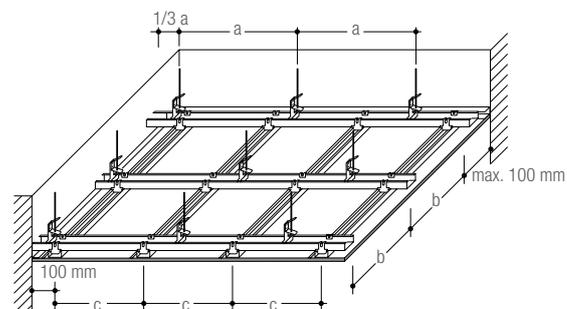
Abgehängte Metallunterkonstruktion nach DIN 18181
